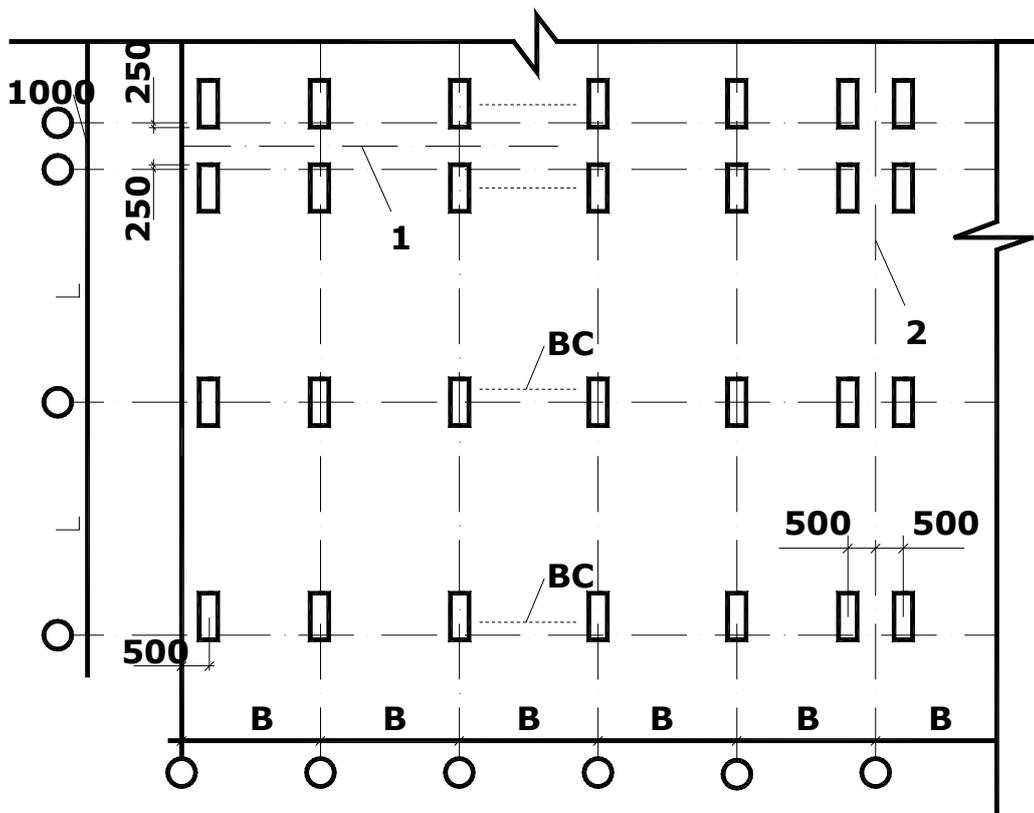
Расположение колонн в плане: 1,2 – оси температурных швов;
